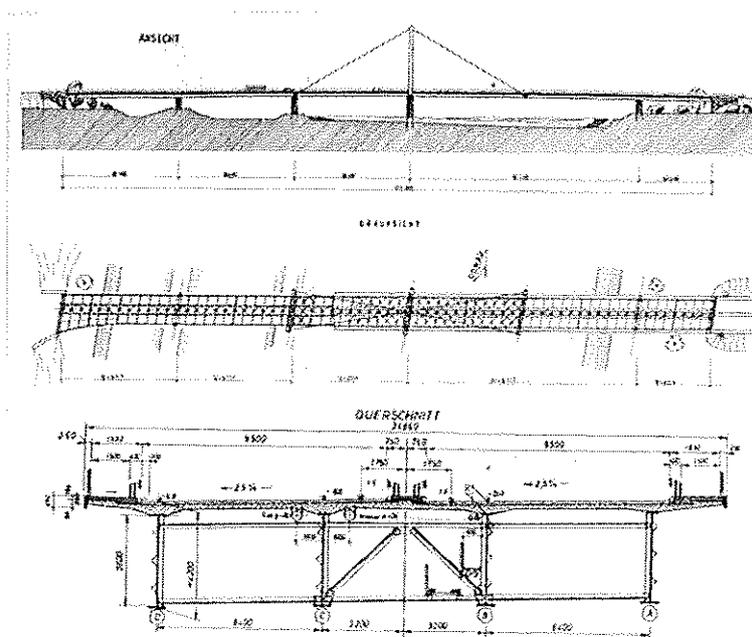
Steyregger Brücke: Ansicht, Draufsicht, Querschnitt
